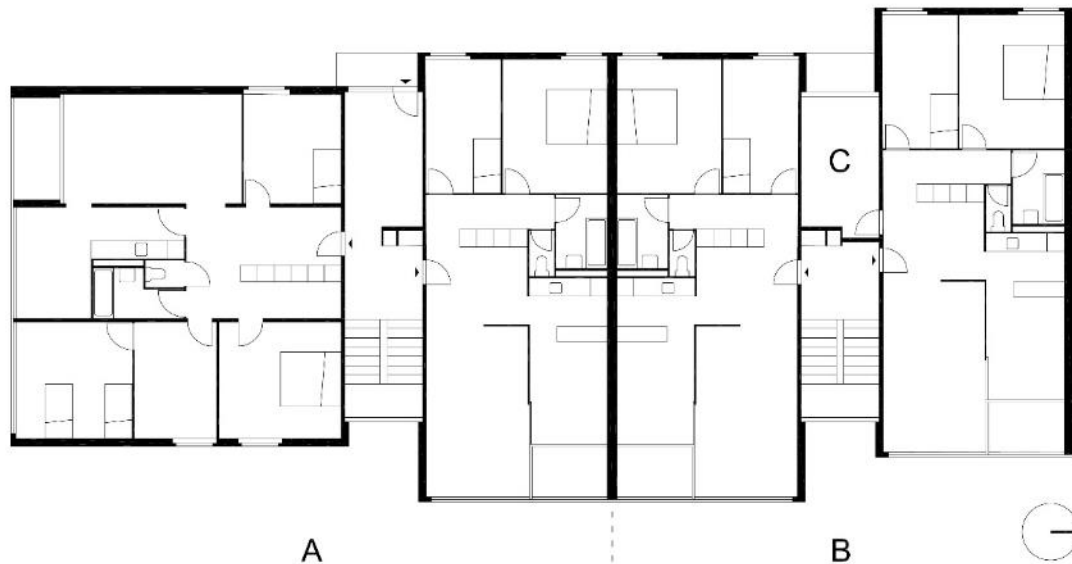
Wohnzeile, Plan Erdgeschoss (A) und 1. Geschoss (B). Eckwohnung mit 4½ Zimmern und 119,6 m², Standardwohnungen mit 3½ Zimmern und 85,8 m². Über dem Eingangsbereich des Wohnblocks ist das Zuschaltzimmer zu sehen (C).
